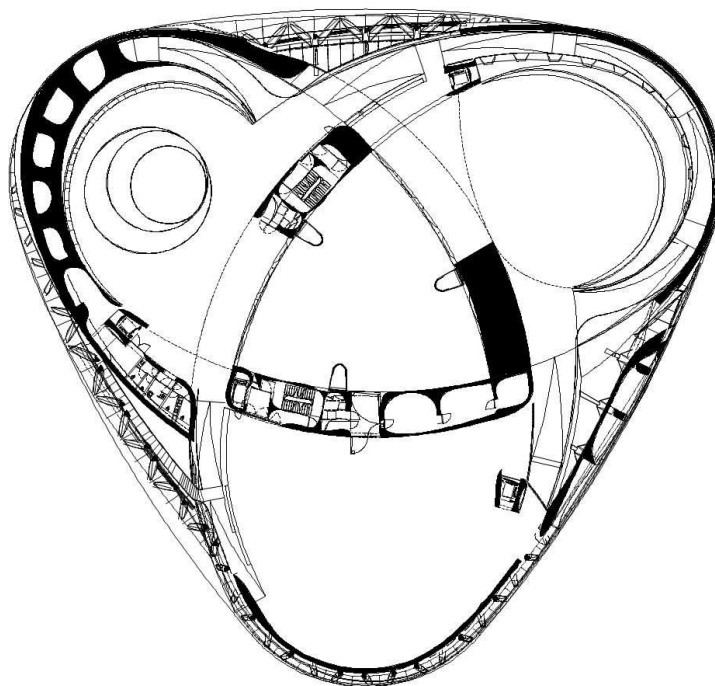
Planta Baixa | Nível 7 Museu Mercedes-Benz. (FONTE: GREGORY, 2009).
